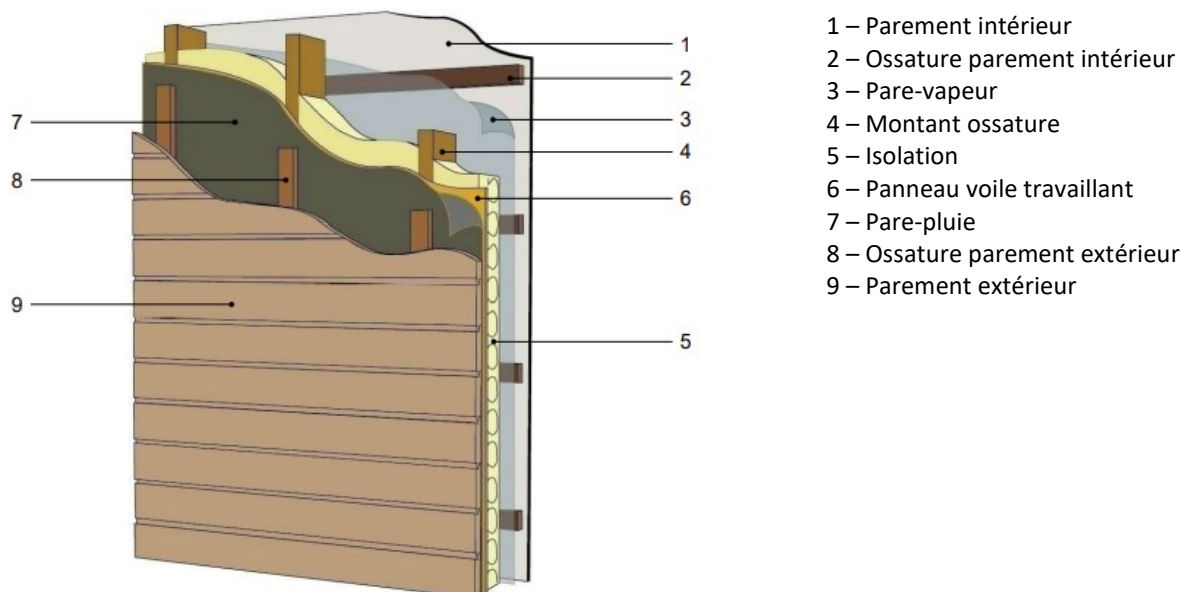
Mur extérieur Ossature Bois avec voile travaillant extérieur et isolant en âme
